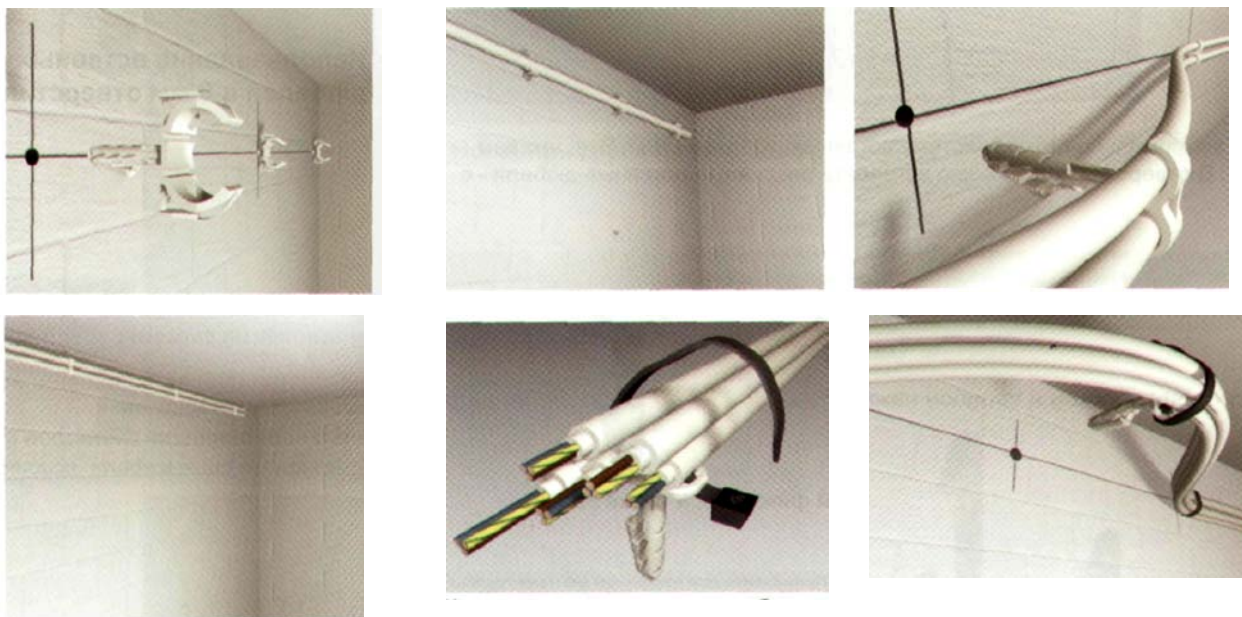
Электропроводки, проложенные открыто непосредственно по строительным основаниям
